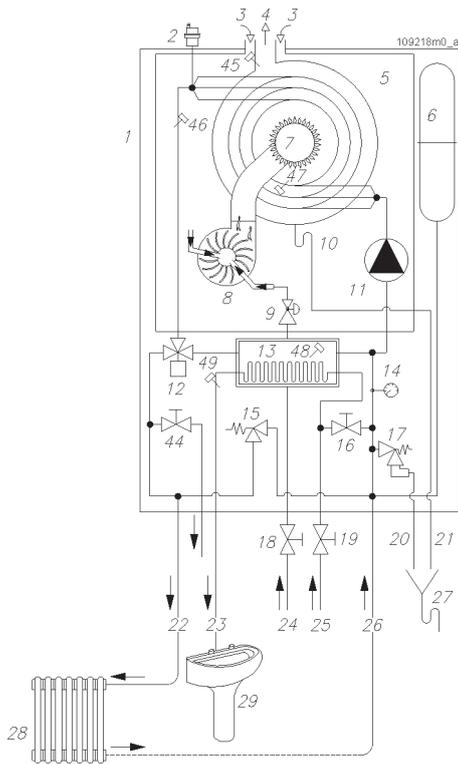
Hydraulikplan Serie WKM mit integrierter Warmwasserbereitung & Heizkörperheizung
